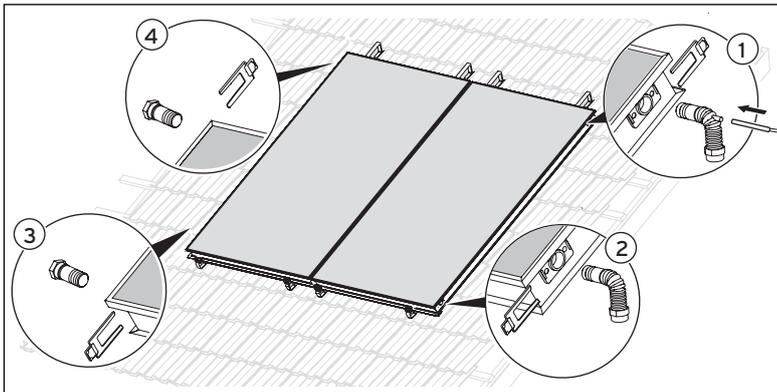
Montage des raccords hydrauliques (1 - 5 capteurs)
